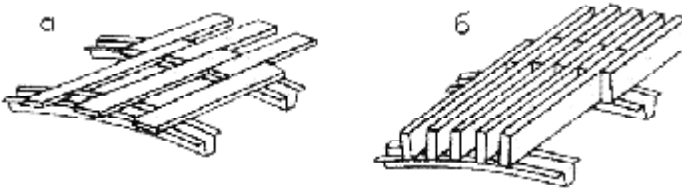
Залізобетонні зтяжки, що встановлені врозгін:
